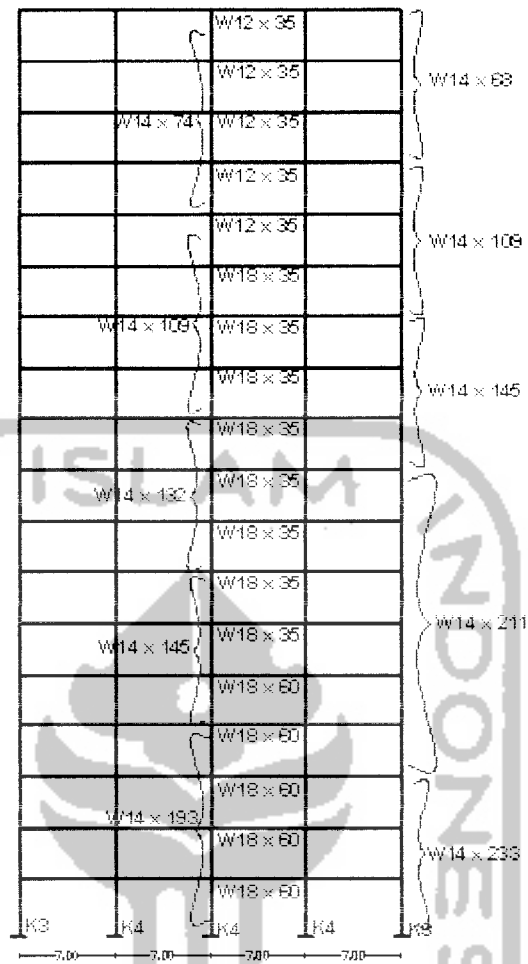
Denah Struktur Dengan Menggunakan Kolom Baja Komposit
